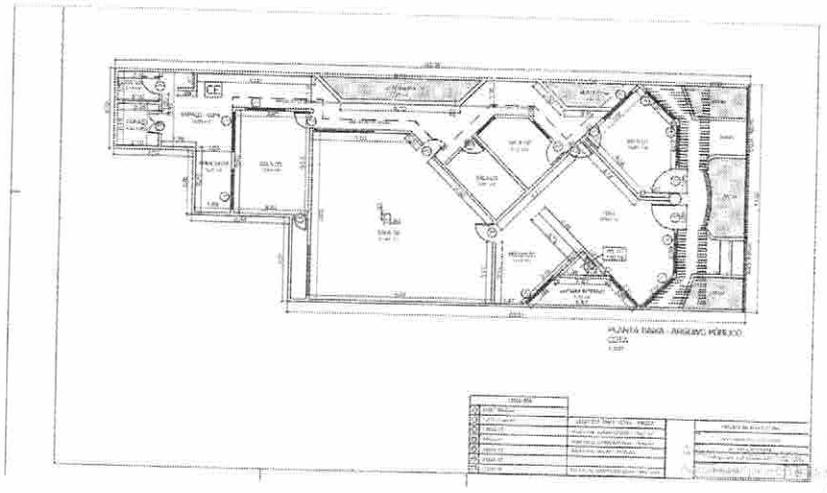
Planta Baixa | Arquivo Público - Av. Hermes Fontes.
